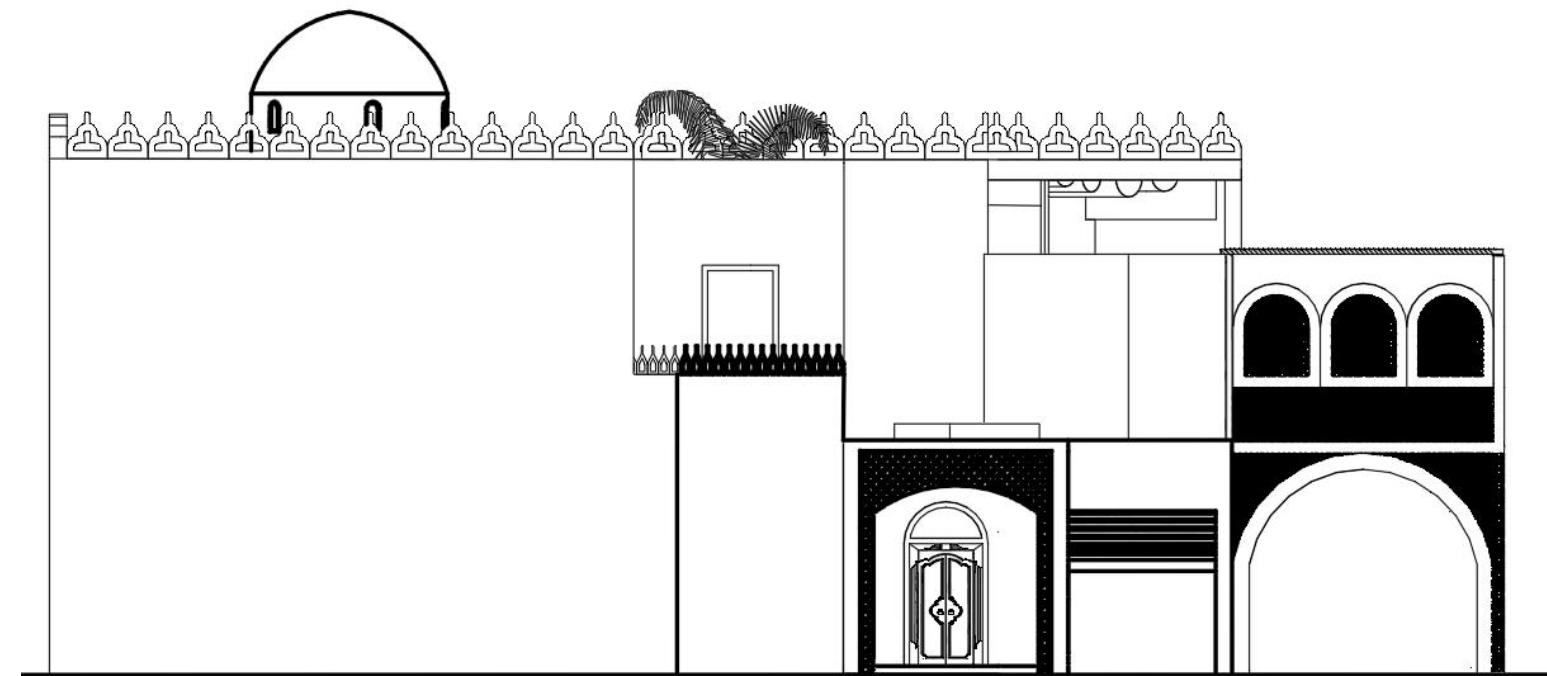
FAÇADE DU LOGEMENT TYPE 3 ; SOURCE: TRAITE PAR L'AUTEUR.
